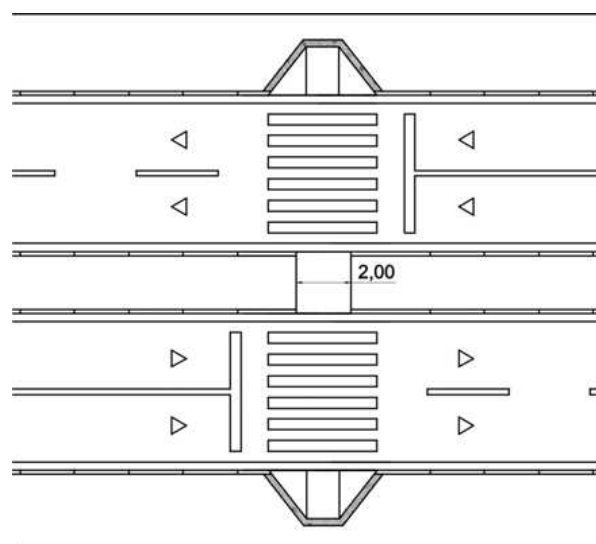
Canteiro divisor de pistas com espaçamento de 2,00 metros (ABNT NBR 9050, 2004).
